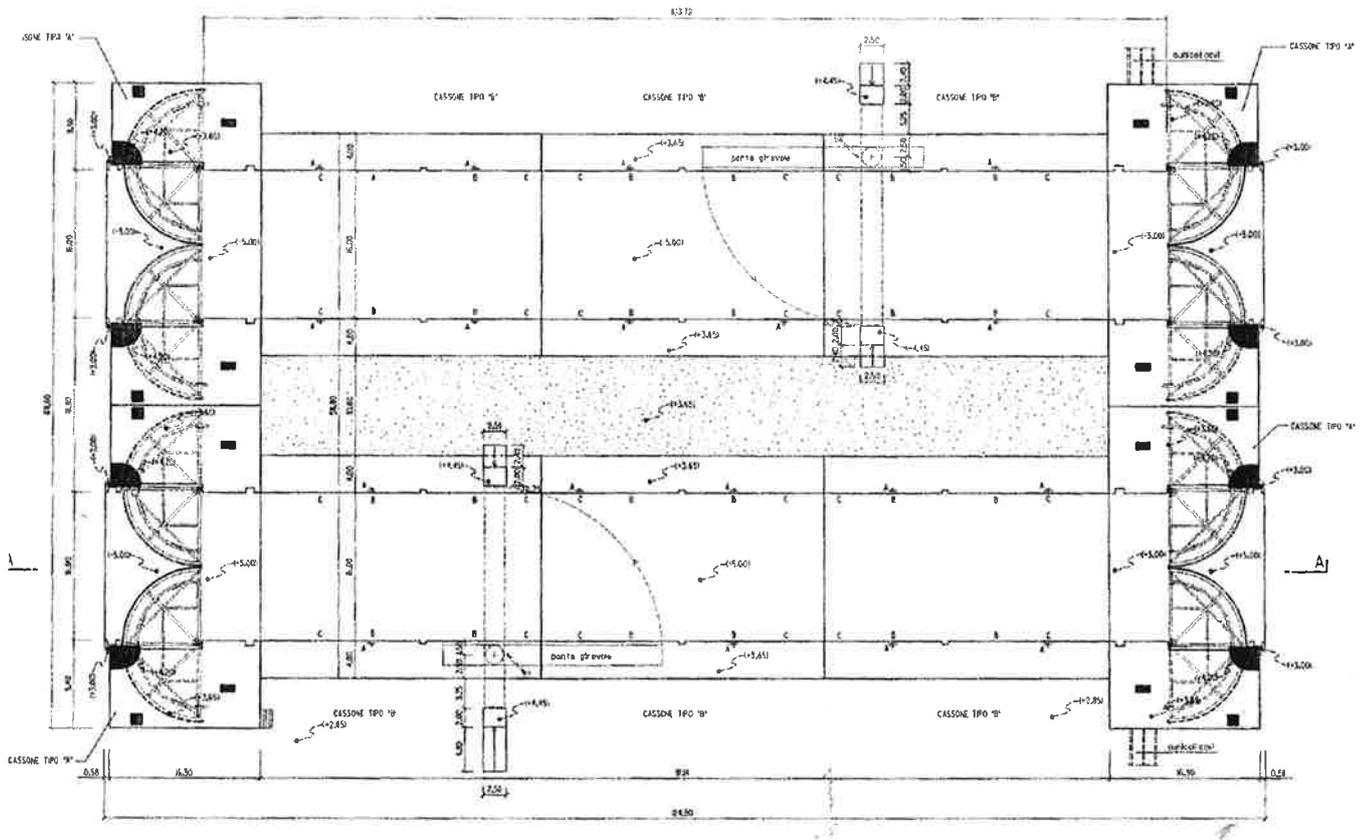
PLANIMETRIA GENERALE CONCHE DI CHIOGGIA PROGETTO DEFINITIVO
